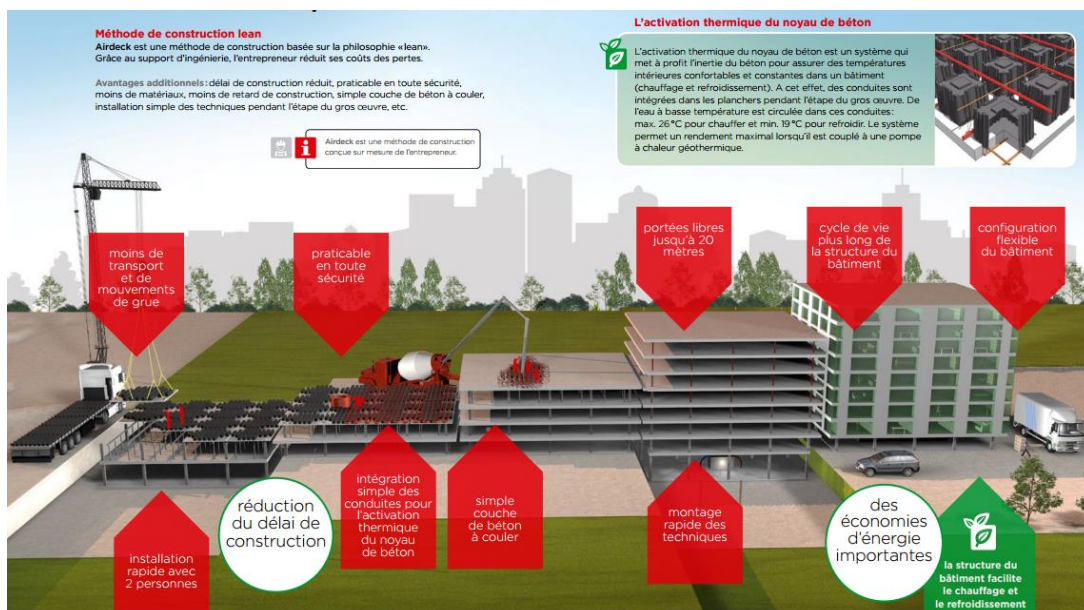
schéma explicatif de mise en œuvre de plancher allégés.
